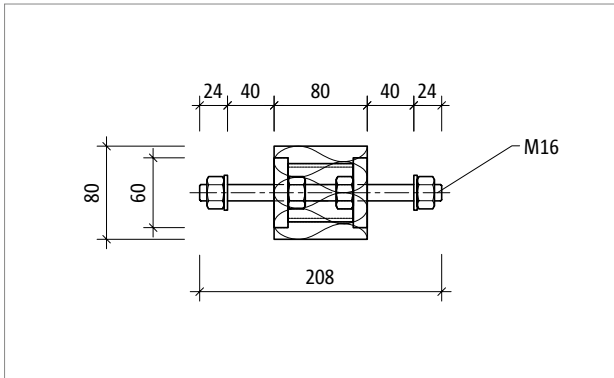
Schöck Isokorb® T type S-V-D16 : coupe du produit
